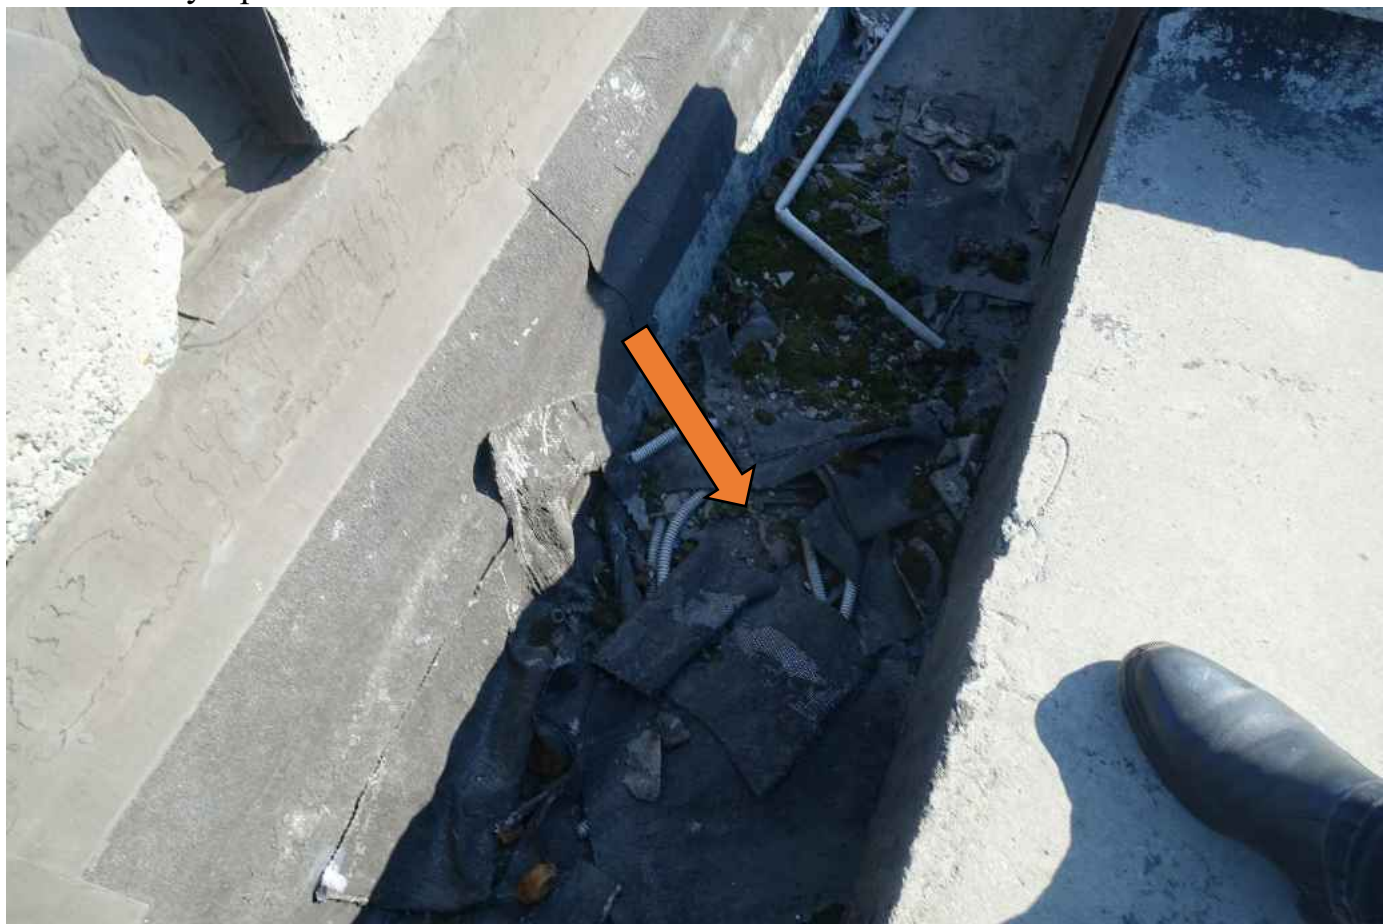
Не качественно проклеенная гидроизоляция. Покрытие разрушается.
